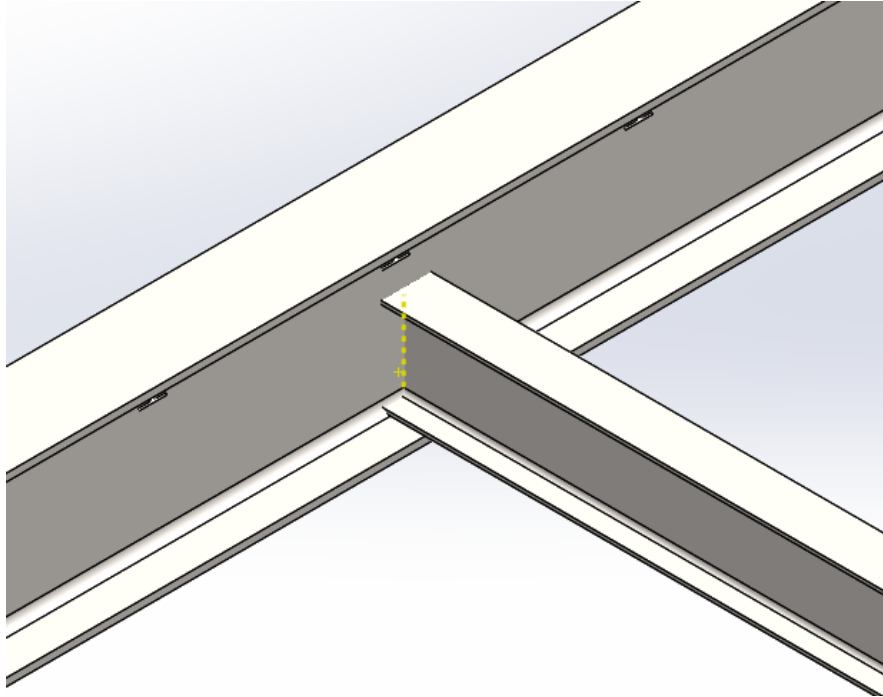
Detalle cordón soldadura de Cartelas
